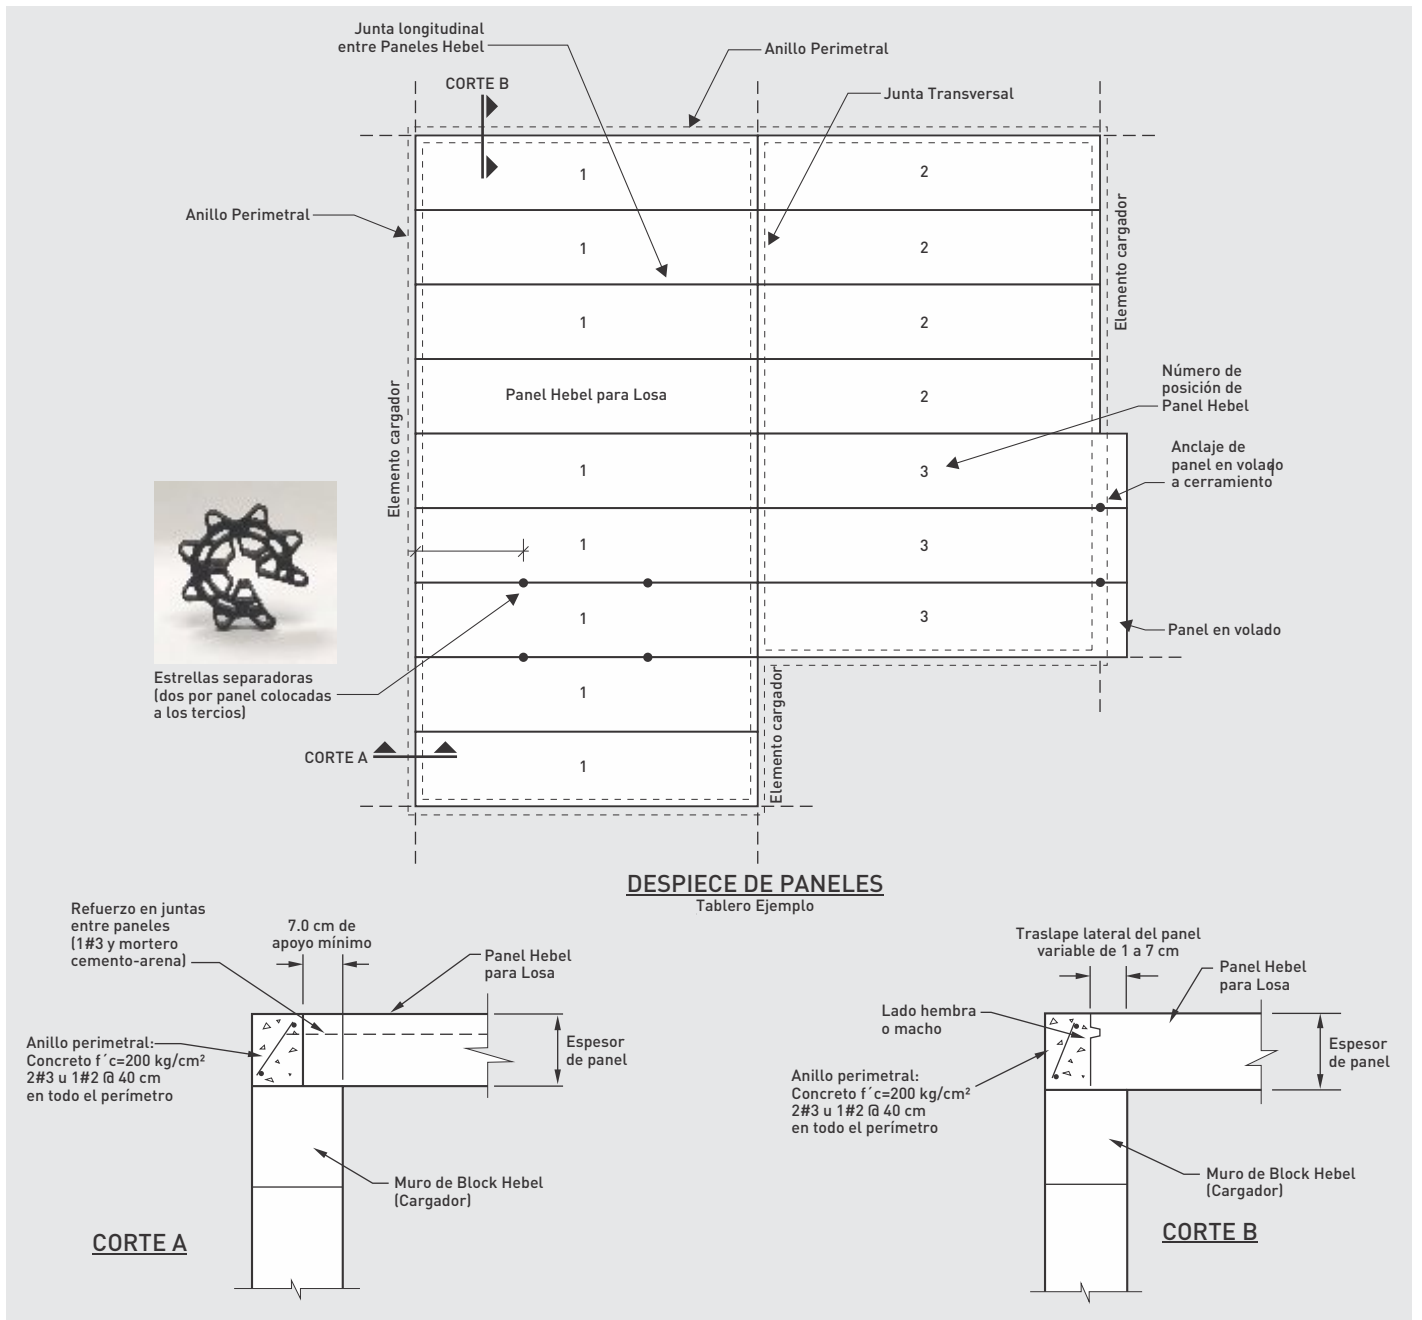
Tablero tipo de apoyo de paneles sobre mampostería.
